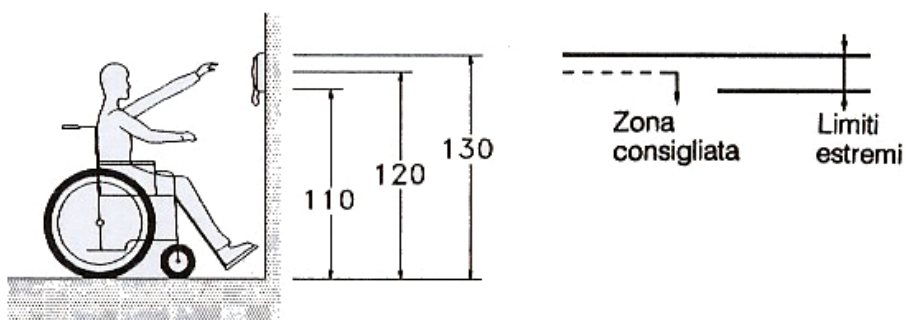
Quote di installazione delle apparecchiature, secondo la norma CEI 64-8 e la guida CEI 64-50.
